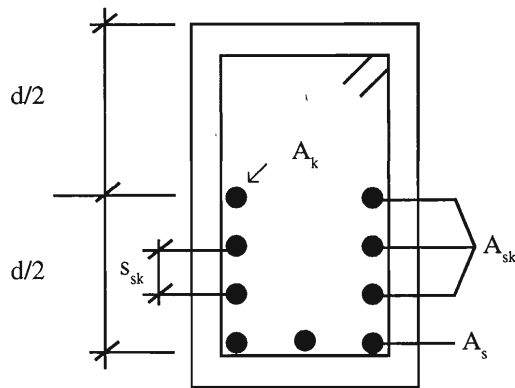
Refuerzo para controlar fisuras en vigas peraltadas
